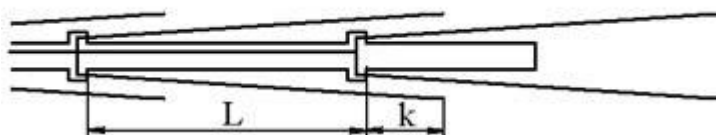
Схема дегазації підготовчих виробок бар'єрними свердловинами
